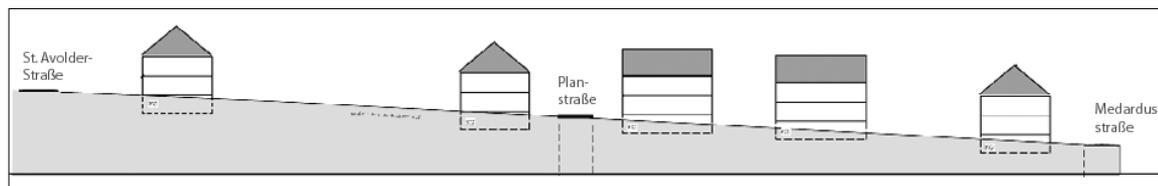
Schemaschnitt St. Avolder-Straße – Medardusstraße (Schnitt A-A siehe Planzeichnung)
